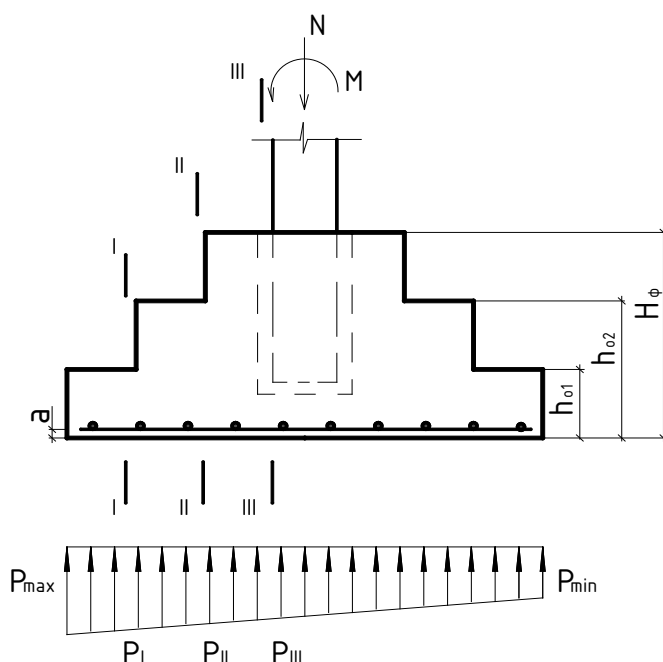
Расчетные сечения фундамента, при расчете ступеней на действие изгибающего момента
